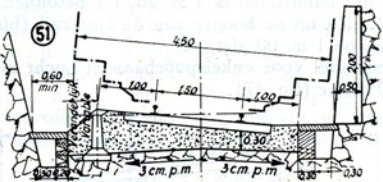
Dwarsprofiel voor enkelspoorbaan in bocht, in rotsachtige ingraving. (De betonnen afbakeningspaal wordt bij uitzondering aan de buitenkant geplaatst).
